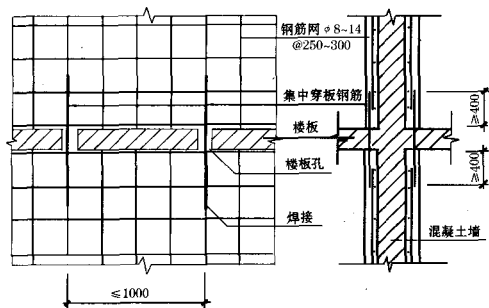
夹板墙加固钢筋网过楼板的穿孔集中配筋
